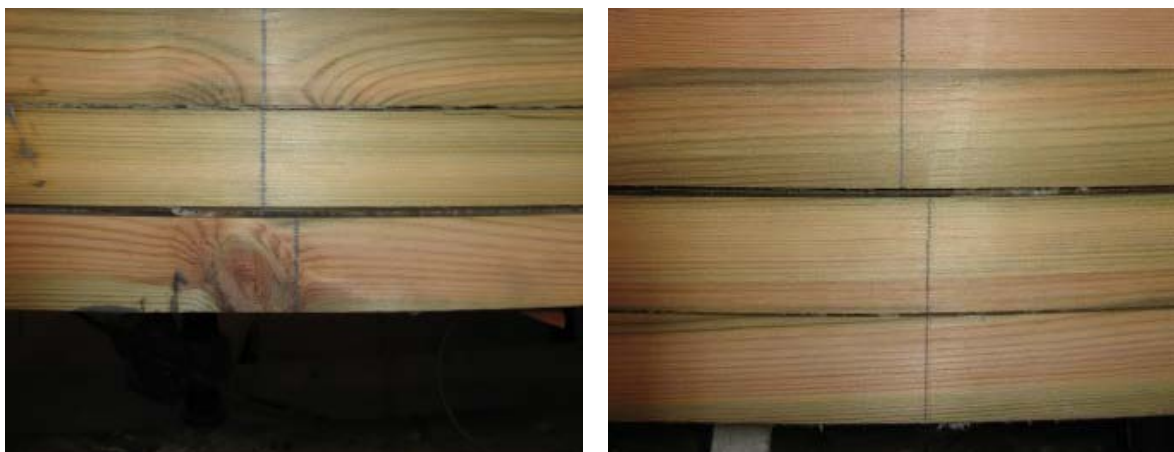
Section 1/4 - Cisaillement clairement visible grâce aux traits verticaux tracés préalablement sur la poutre.
